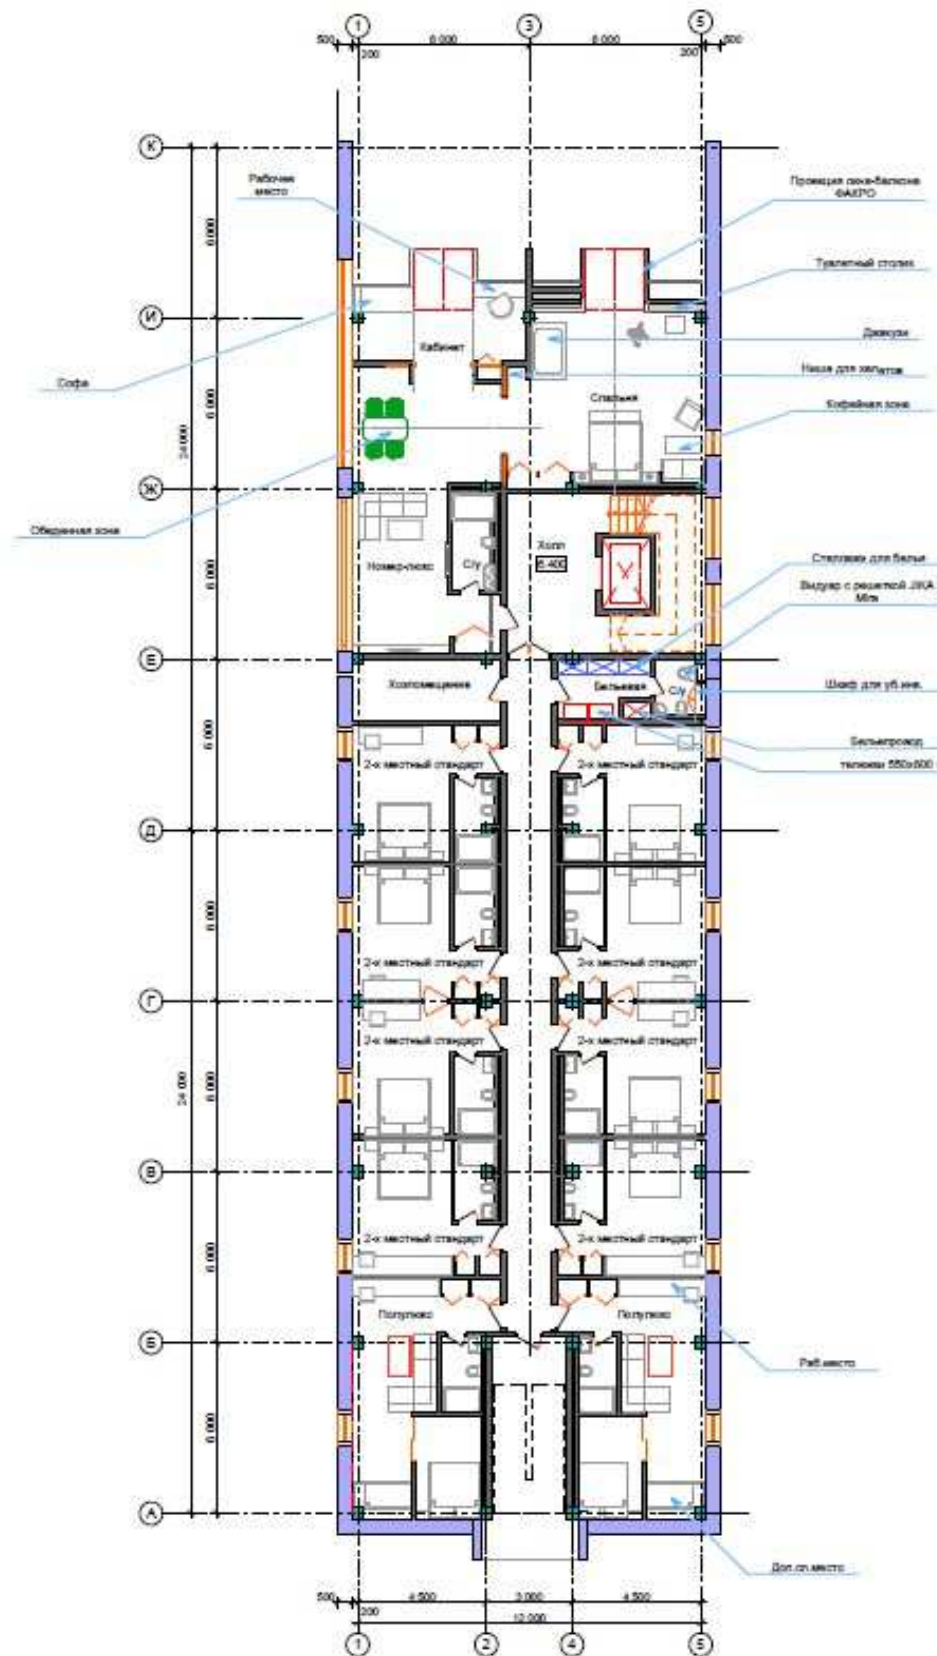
План 3-го этажа (на отм. +6,400)
